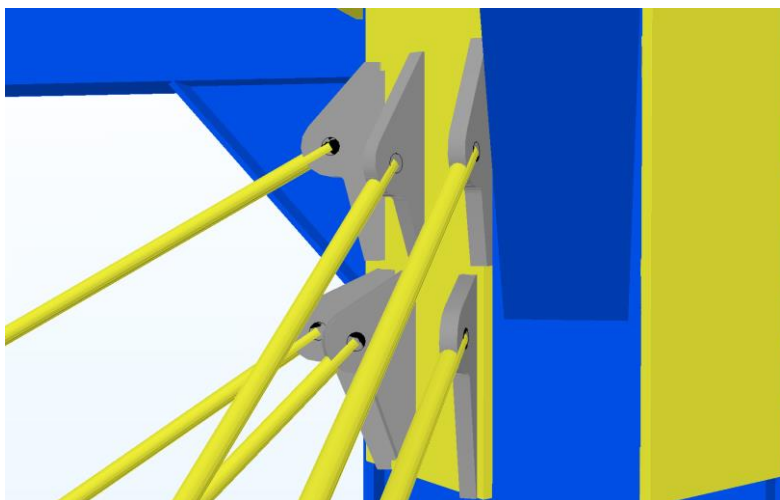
Zavěšení spodní části tubusu na ocelových táhlech Macalloy (BIM sight)
